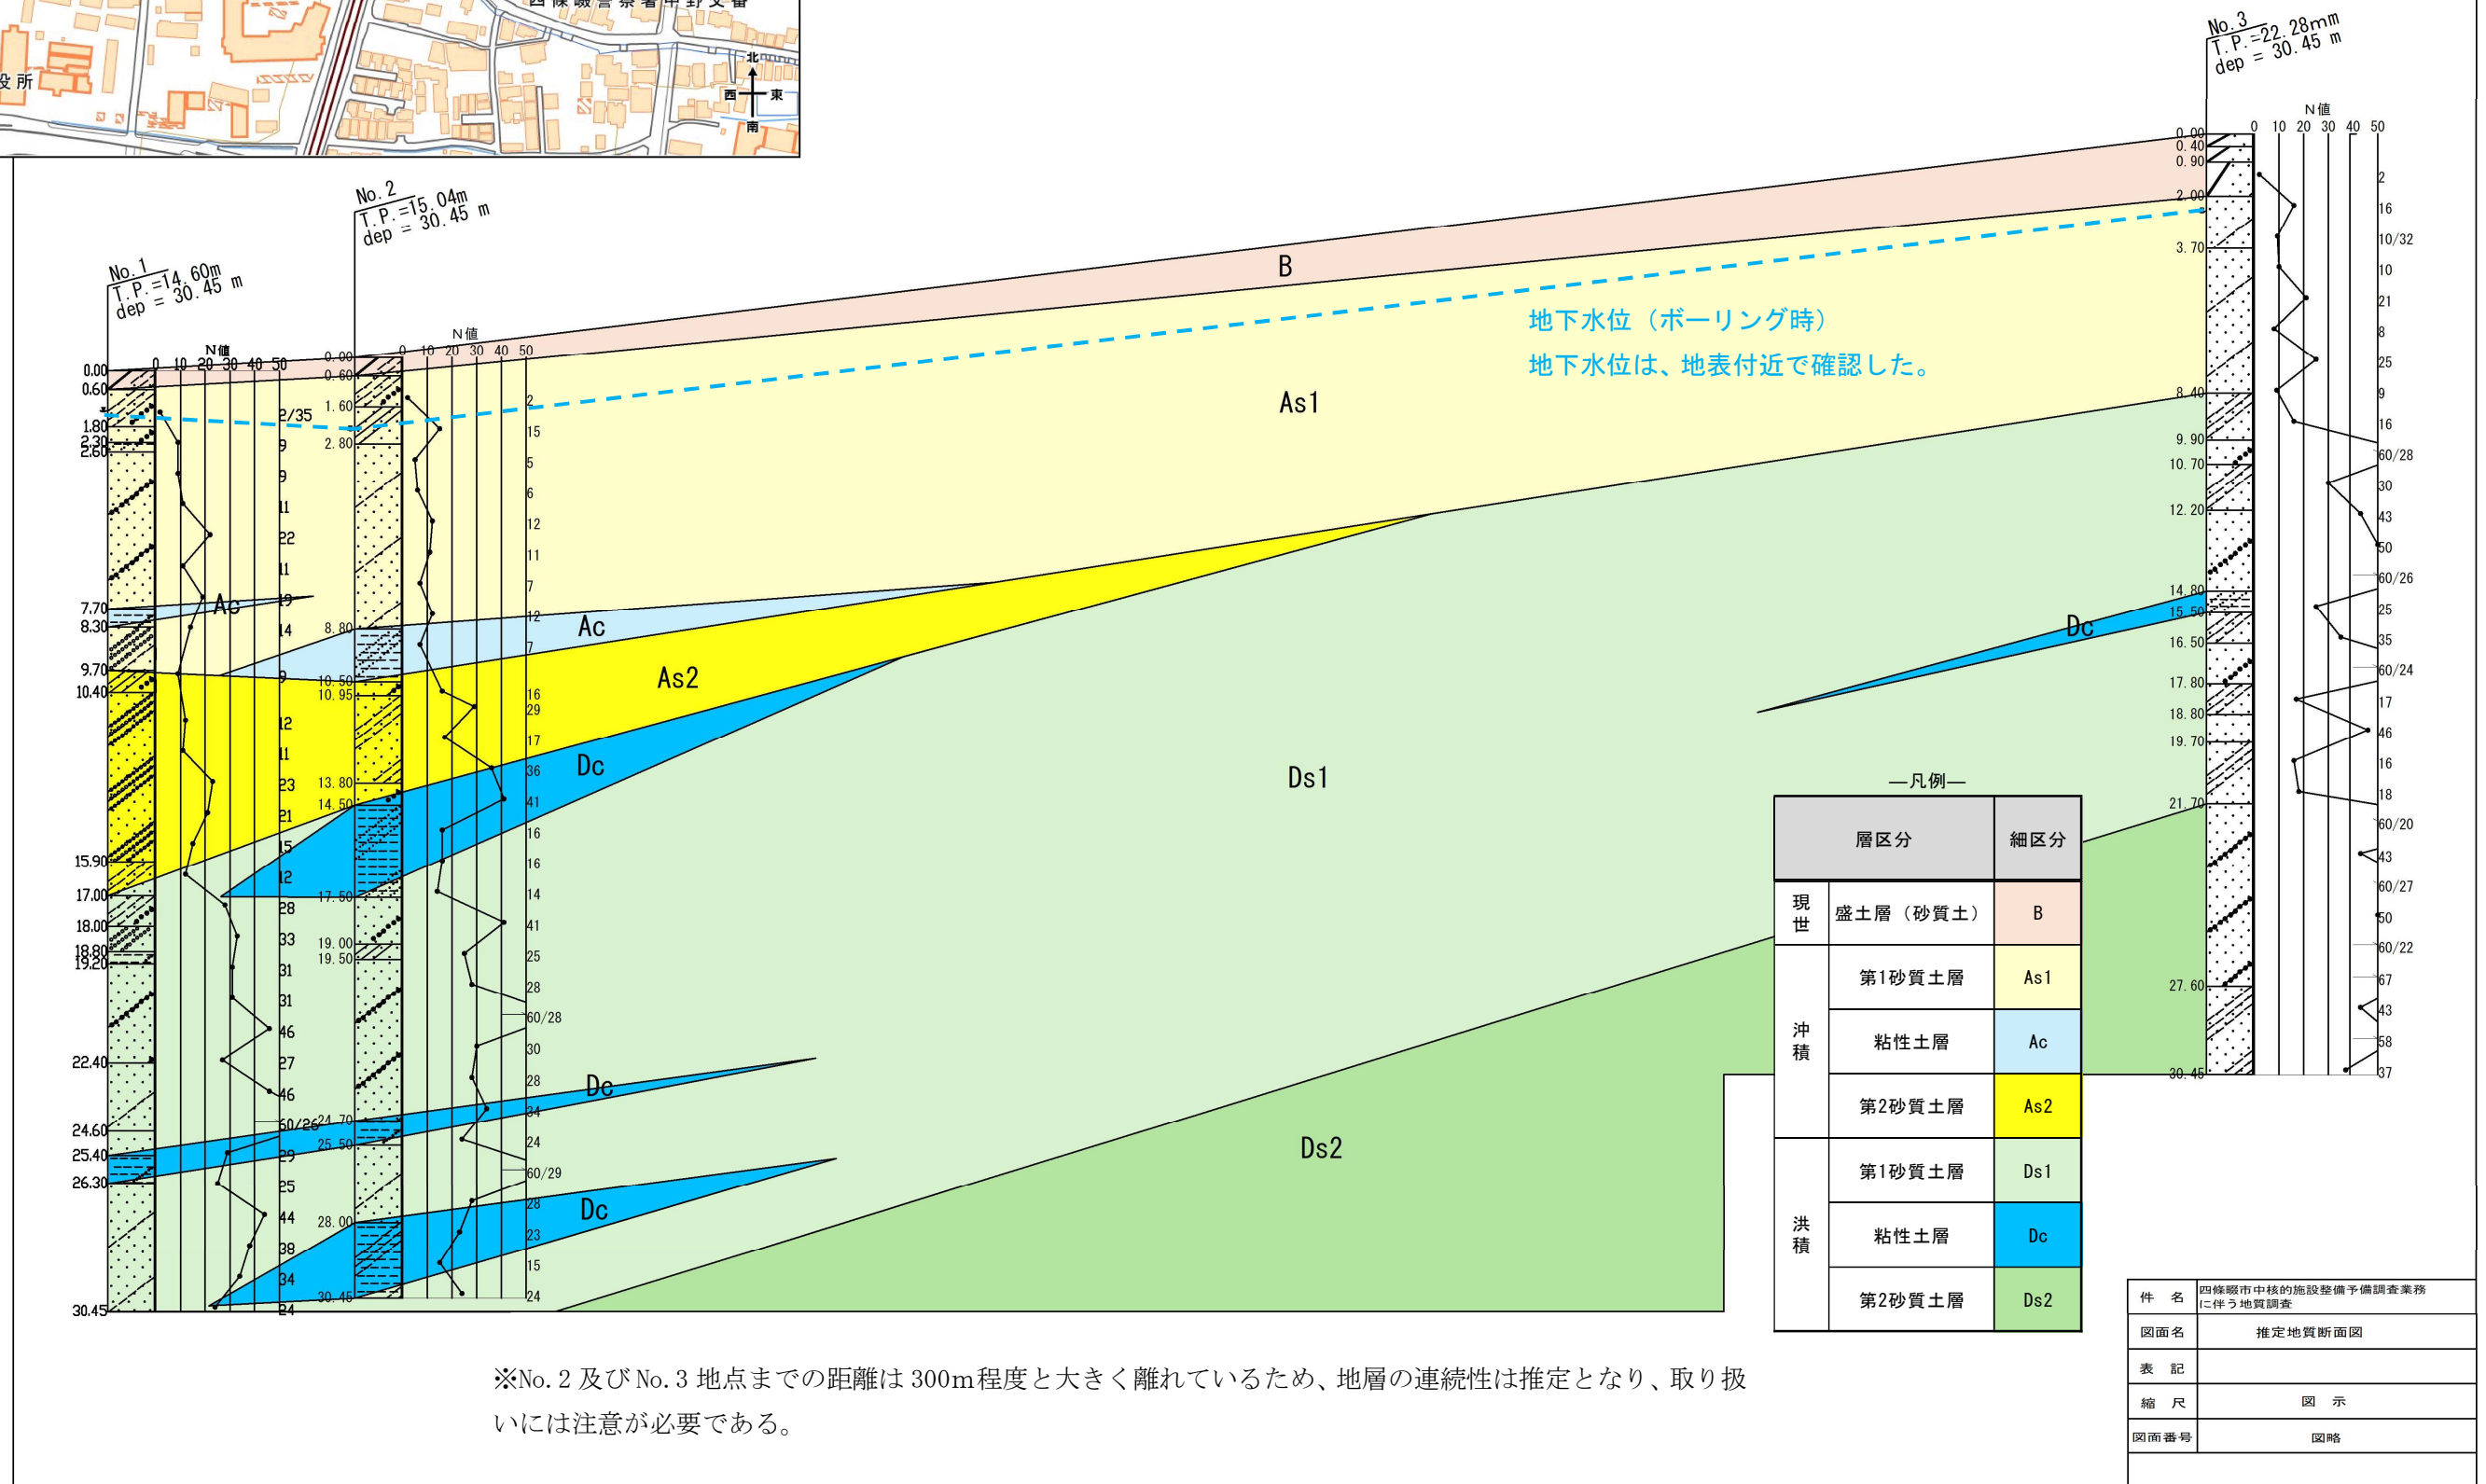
推定地質断面図 (No. 1~No. 3)
